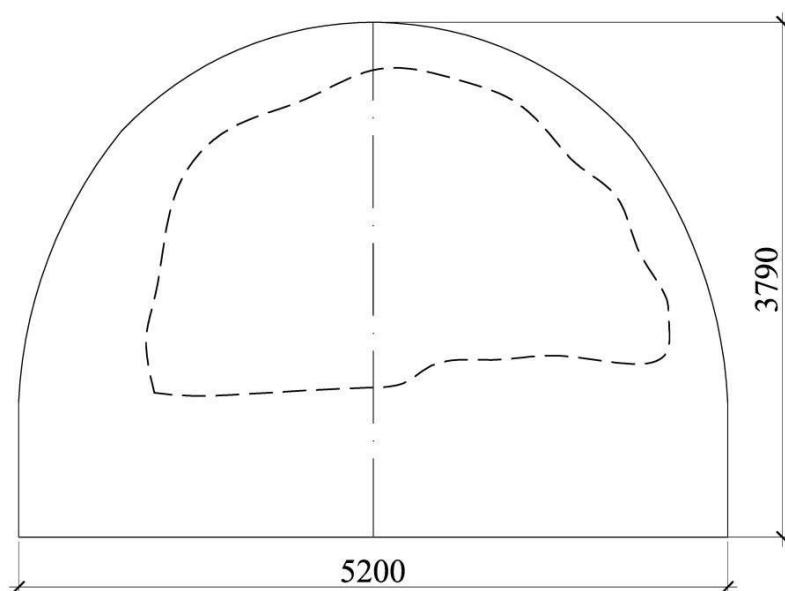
Ескіз перерізу вентиляційного штреку на ділянці 20 м попереду лави
